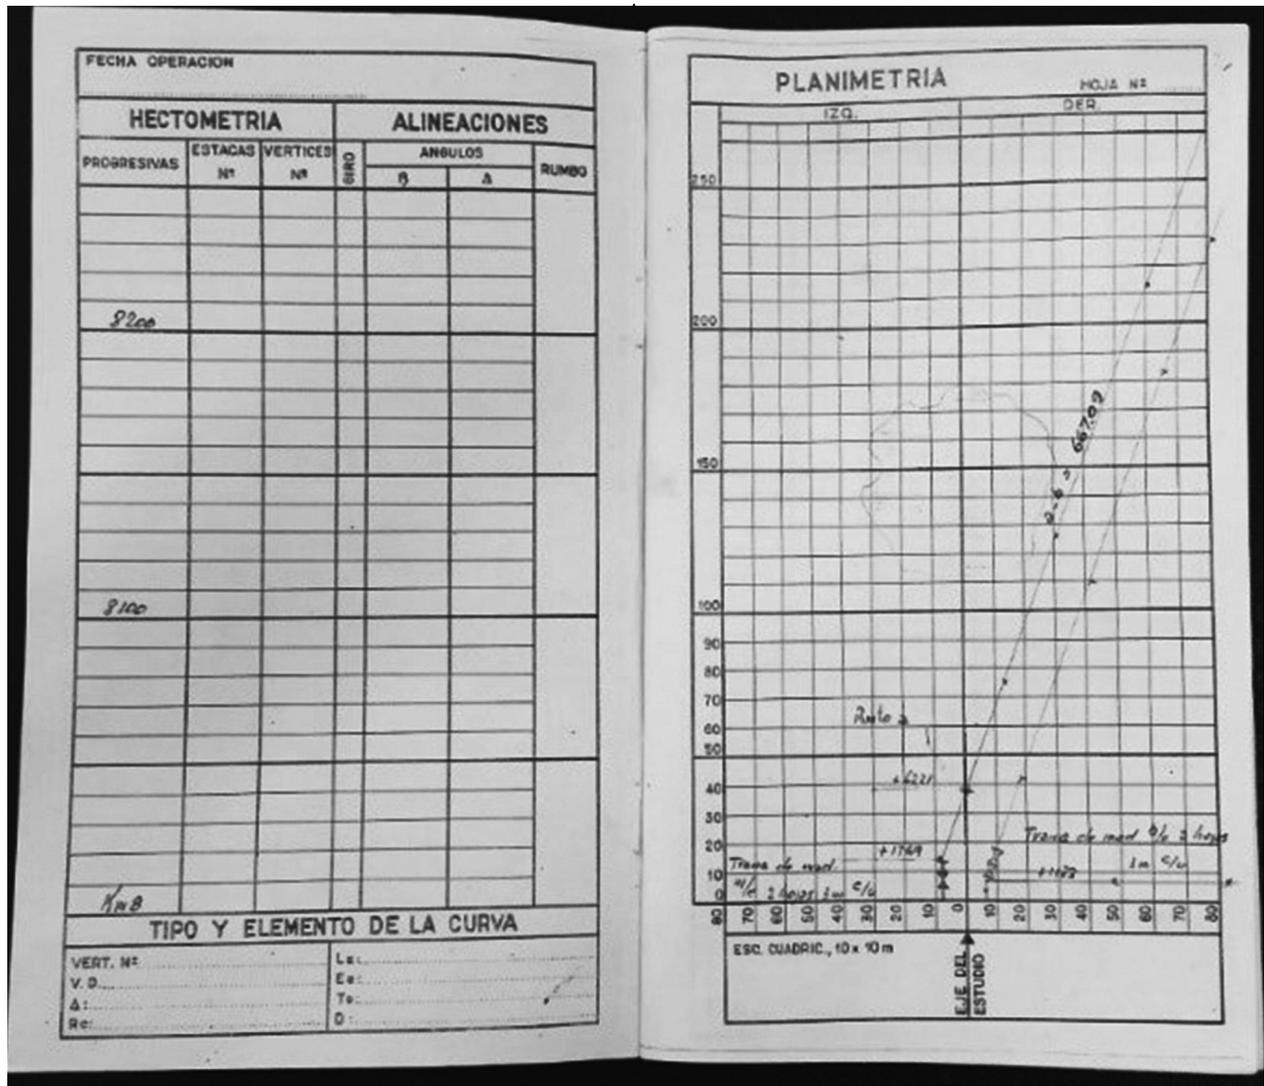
Libreta de levantamiento planimétrico. Fuente: Dirección Provincial de Vialidad.
